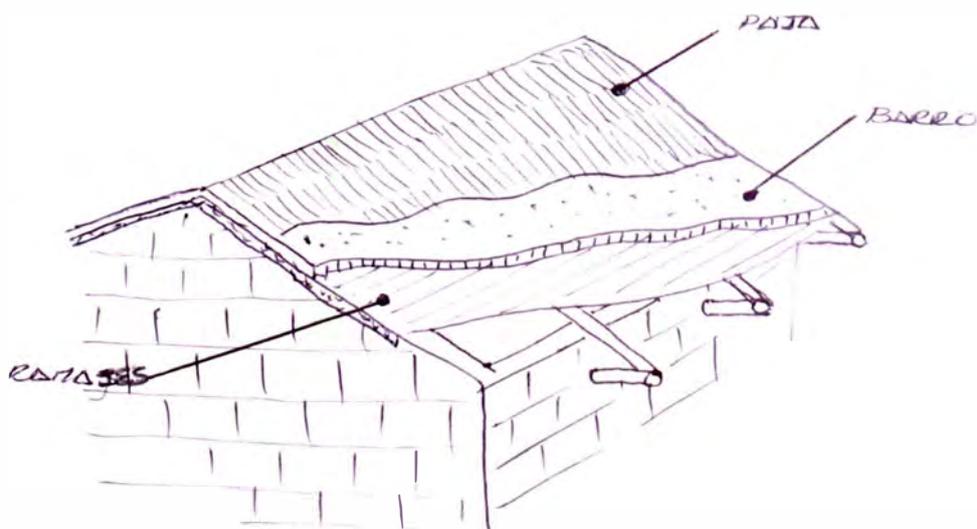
TECHO RECUBIERTO CON PAJAS Y ASENTADAS CON BARRO
